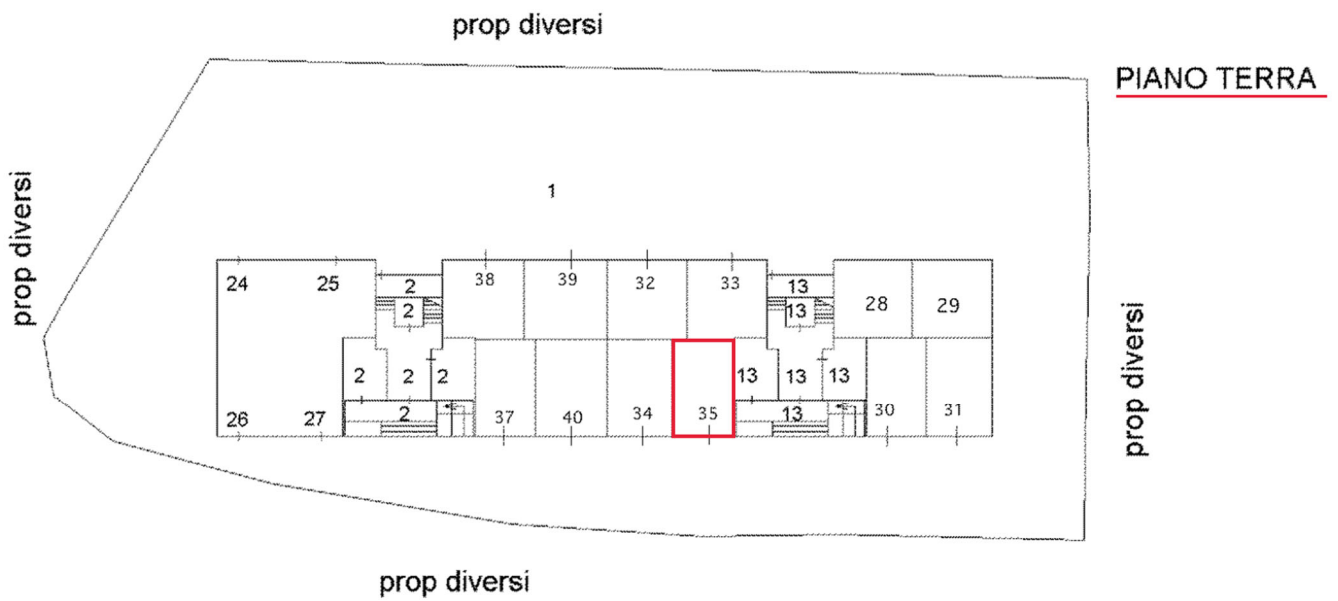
Ubicazione del cespite all'interno del Fabbricato (Stralcio dell'elaborato planimetrico catastale)
